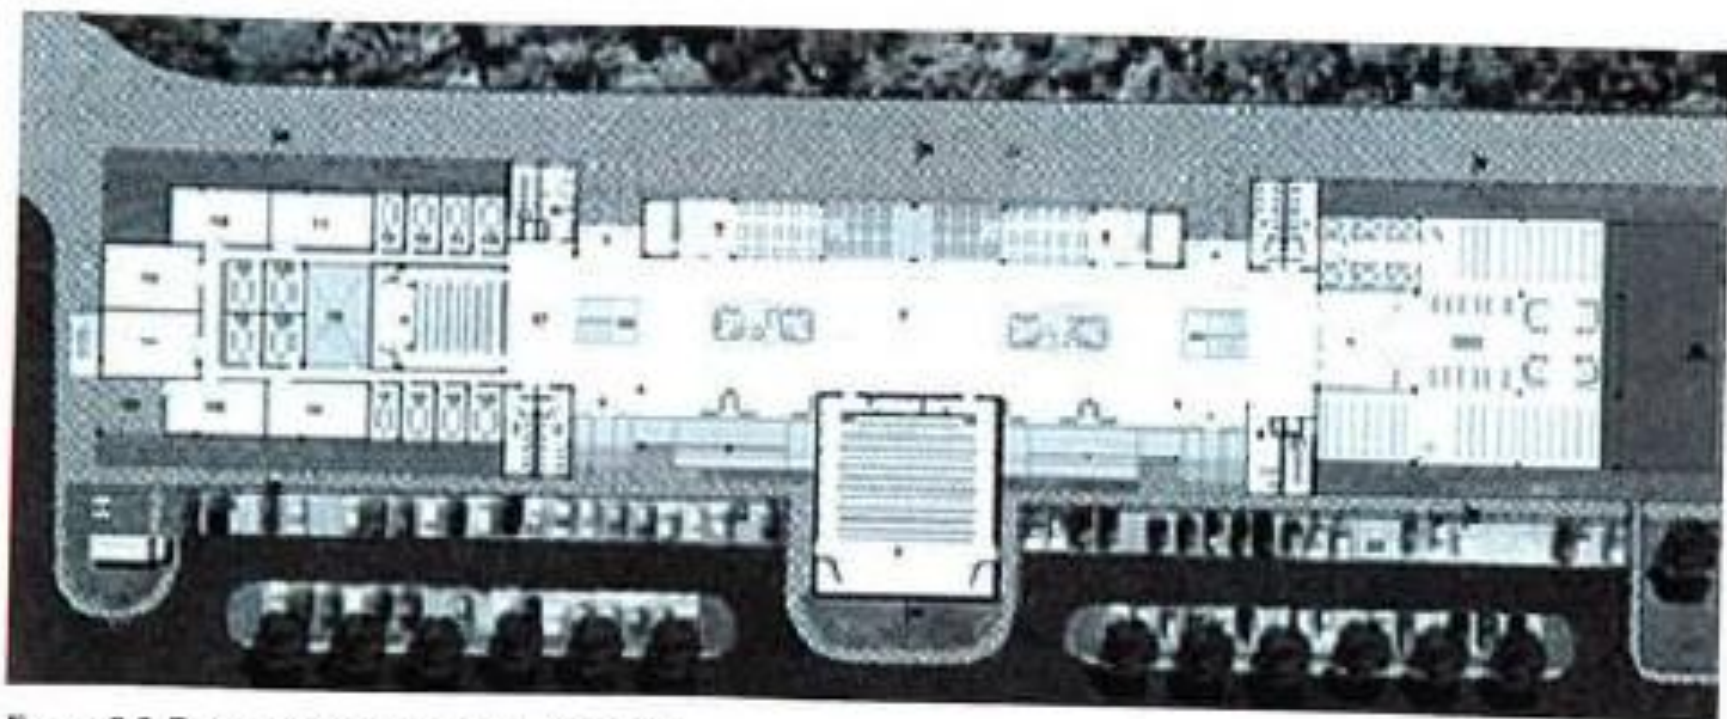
PLANTA TÉRREO DO BLOCO ACADÊMICO
